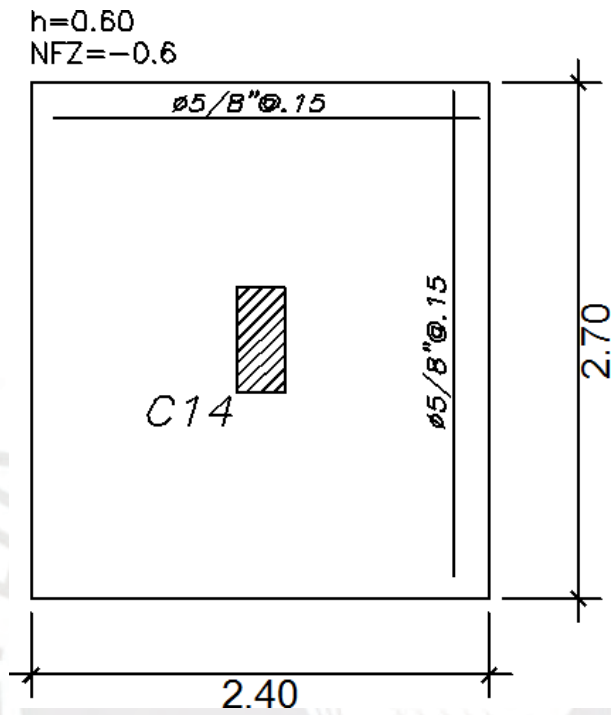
4. Diseño final de la zapata aislada de la columna C-14
